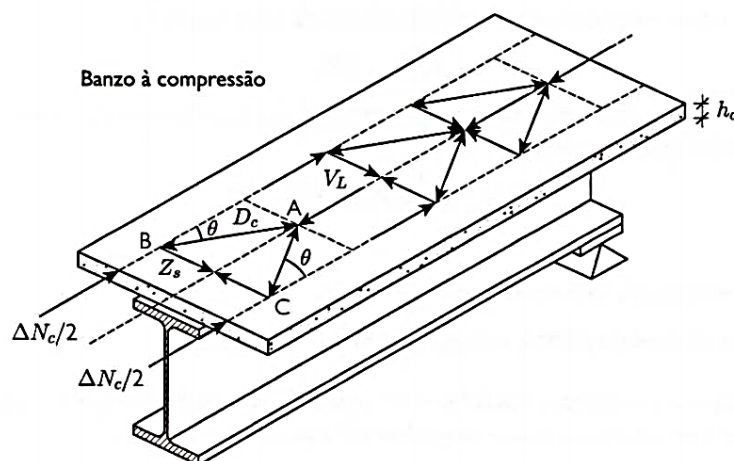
Modelo de escoras e tirantes para verificação do corte longitudinal em viga mista (Calado e Santos, 2010).
